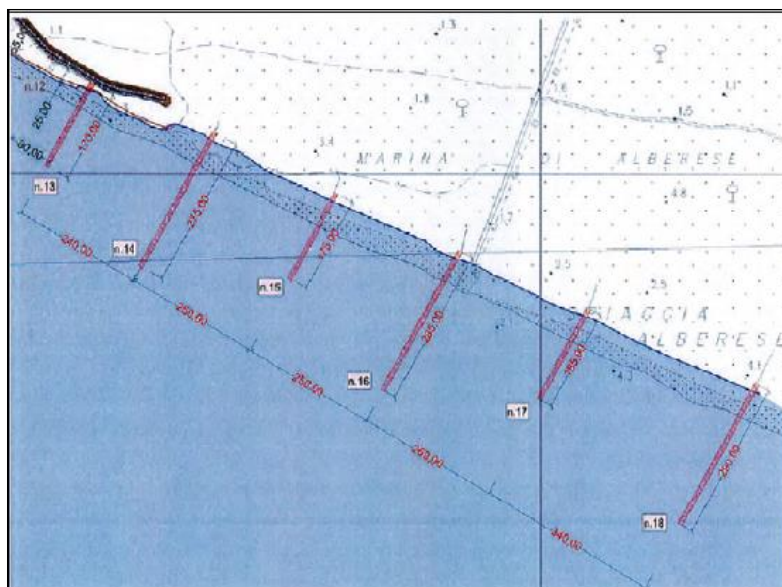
Localizzazione planimetrica della batteria dei pennelli a mare (sommersi).
